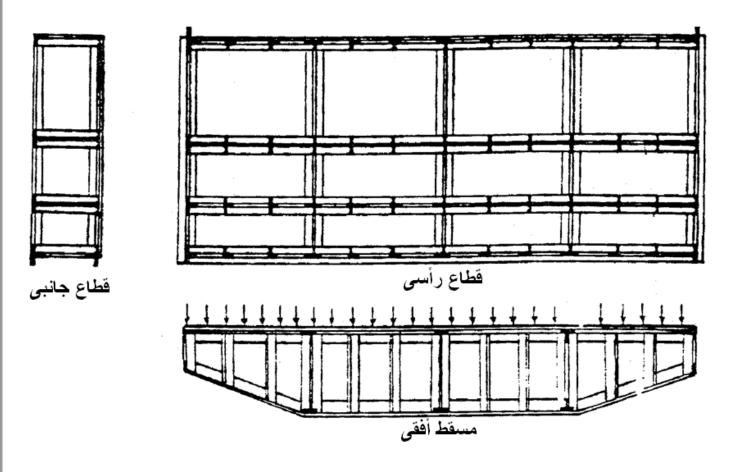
تدعيم البوابات المستوية بكمرات أفقية رئيسية وكمرات رأسية ثانوية
